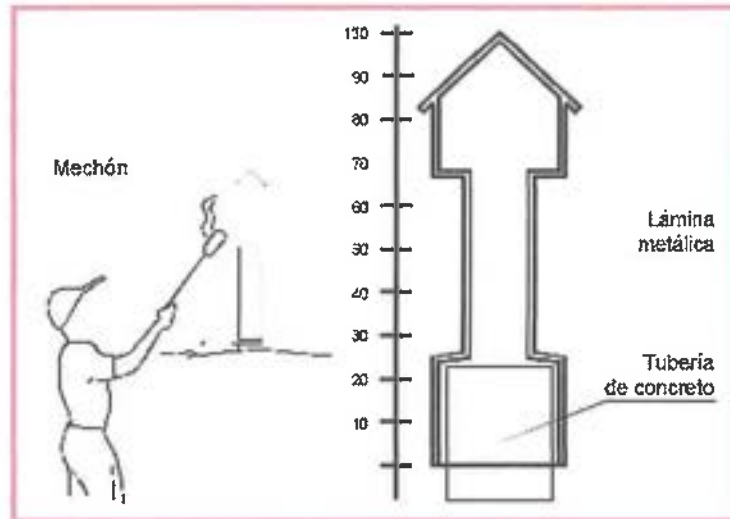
Tapa metálica para la protección del drenaje de gases.
